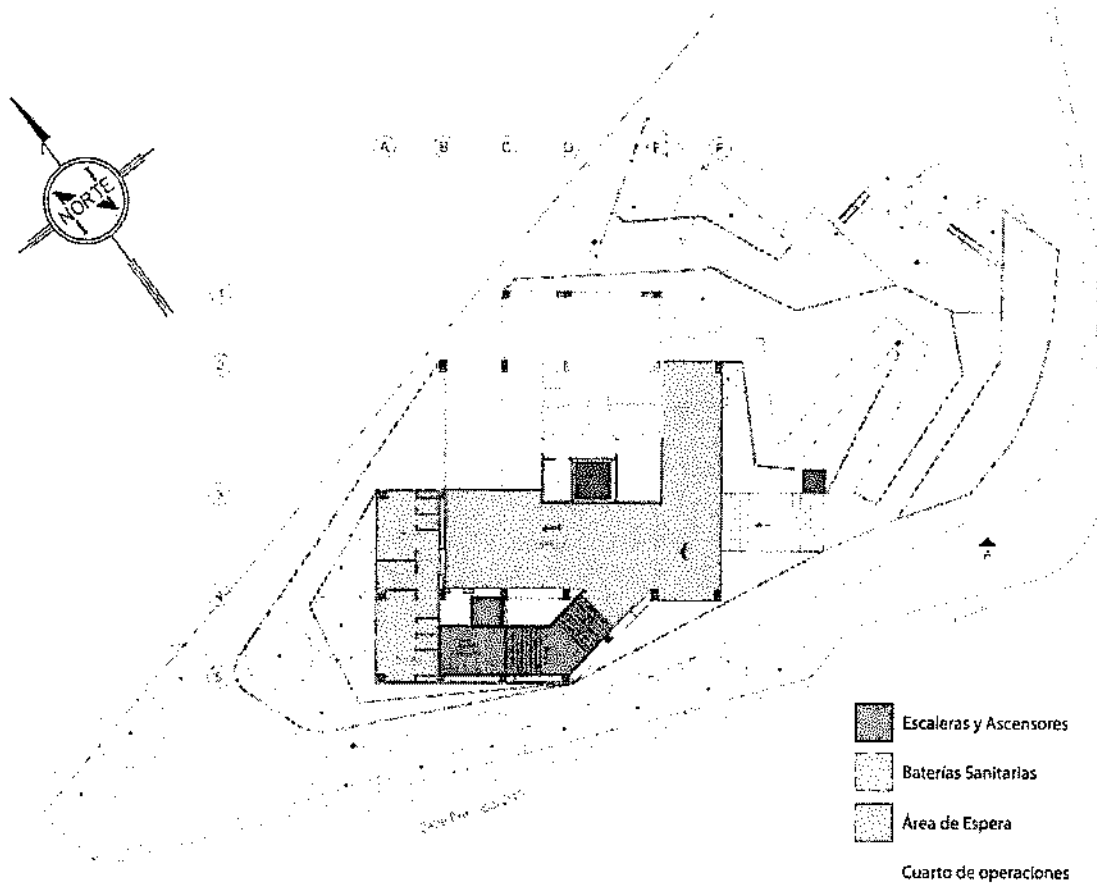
PLANTA BAJA ROLDÓS. Fuente: Consultor
